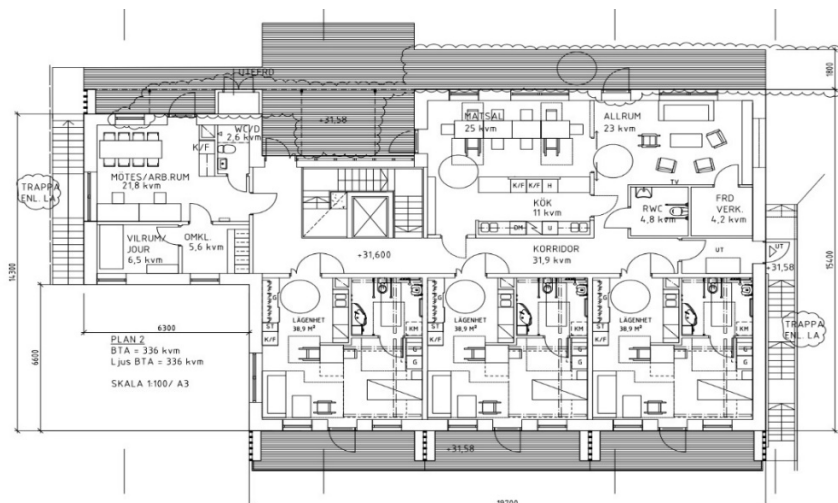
LSS-boende, plan 2. Upprättad 2022-03-16, reviderad 2022-05-13
